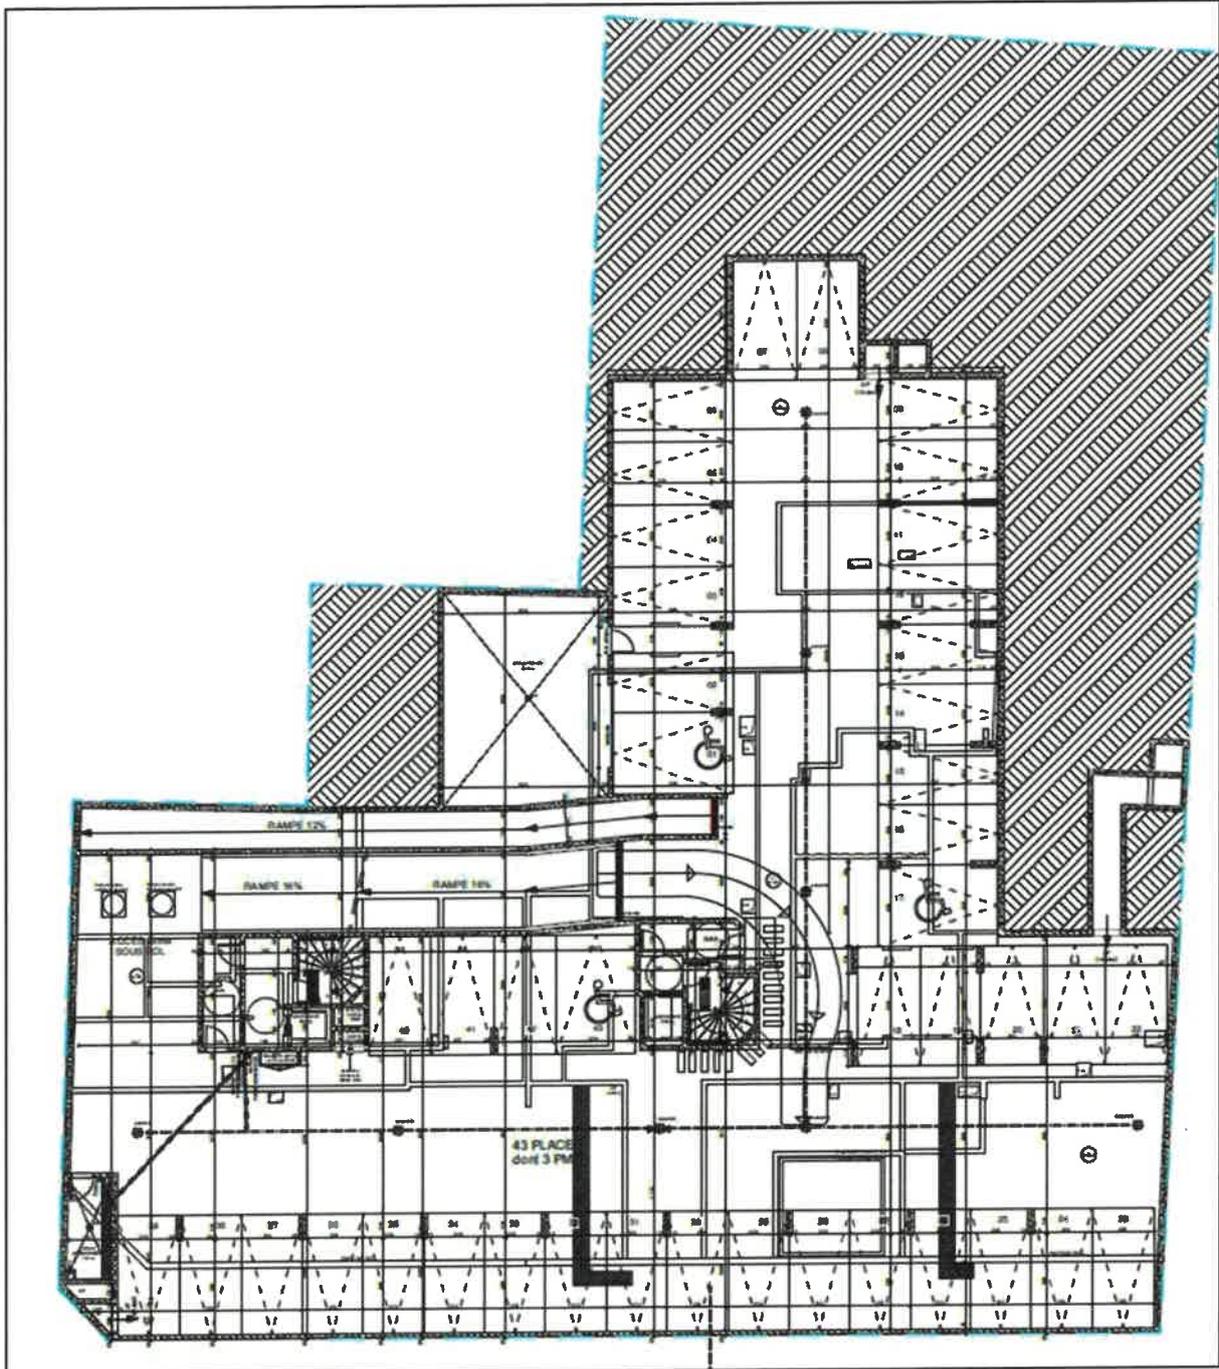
Plan du sous-sol du projet (Source : Agence GIRAT Architectes)
